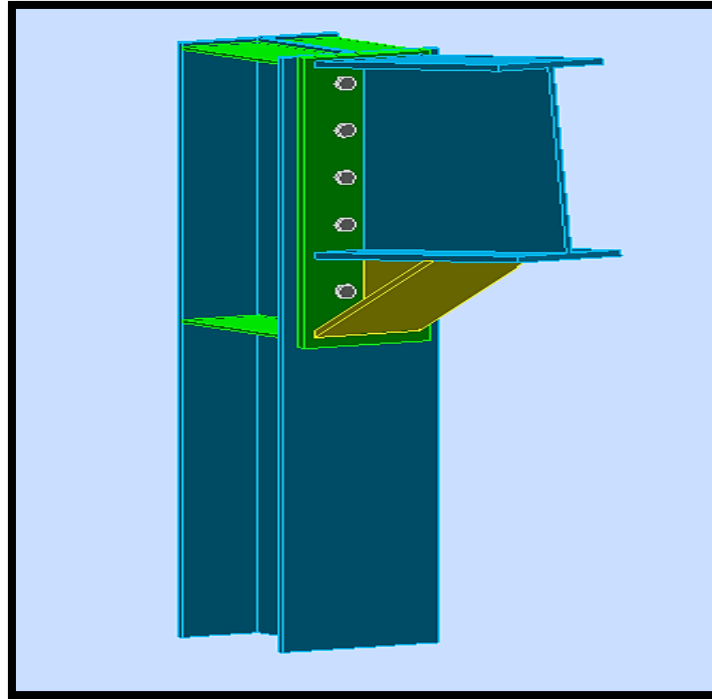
Vue en 3D de l'assemblage Poteau-traverse.
